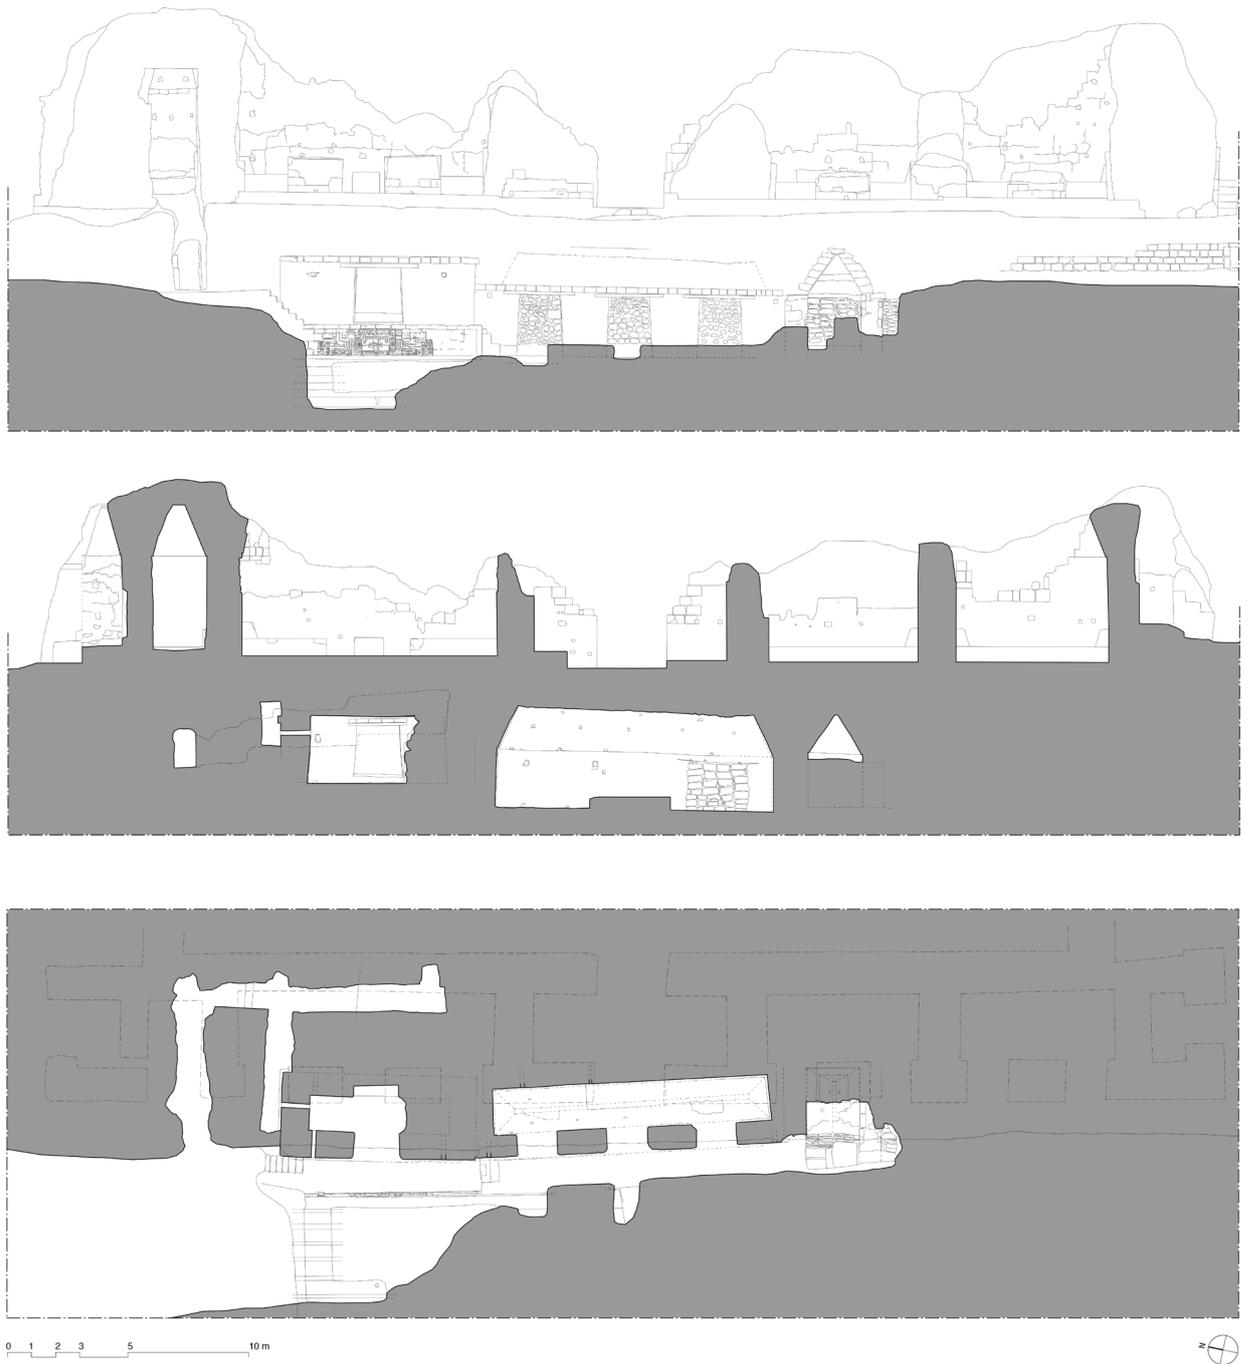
Levantamiento realizado a partir del modelo 3D del edificio 6J2 Sub de La Blanca. Alzado general con la Acrópolis, sección y planta.
